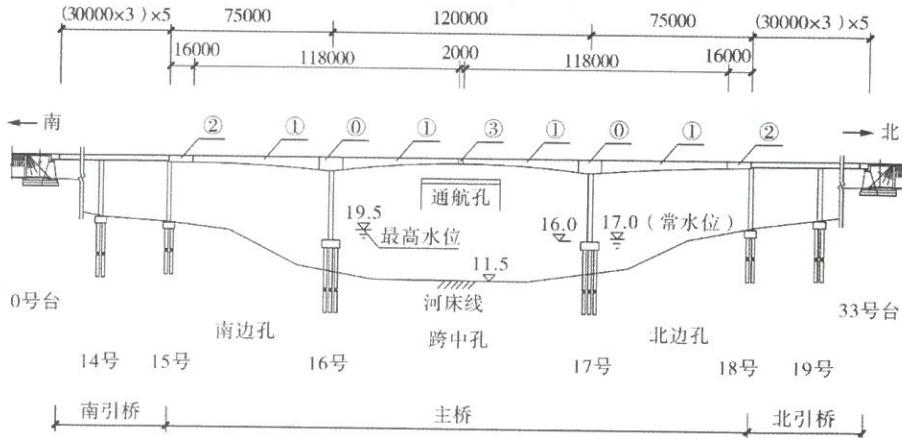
桥梁立面布置及主桥上部结构施工区段划分示意图
